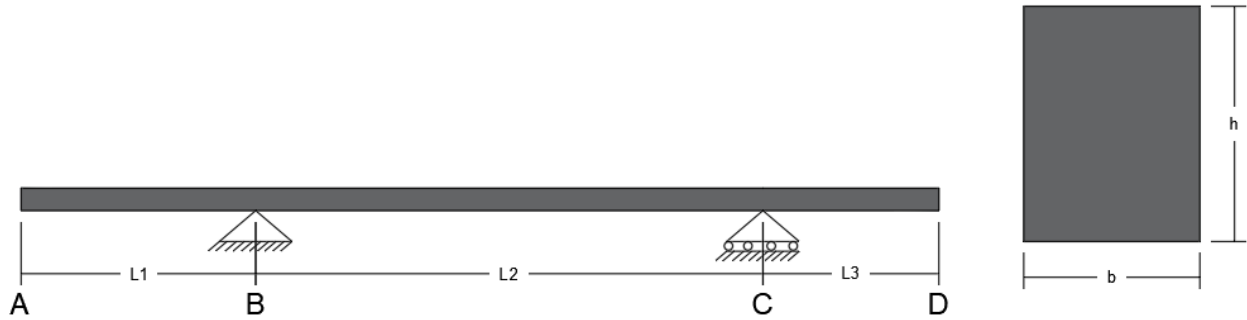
Viga de dos luces - Corte transversal y longitudinal.
